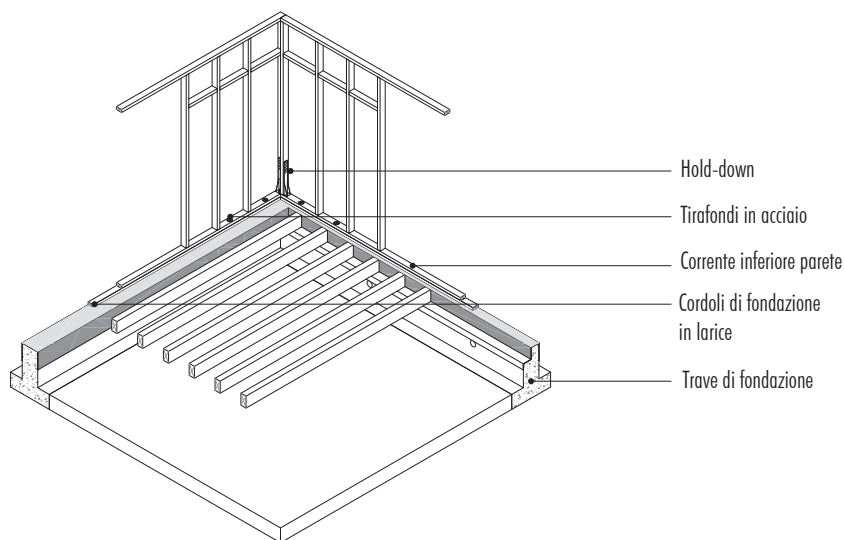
Collegamento alle fondazioni per un edificio Platform Frame.
